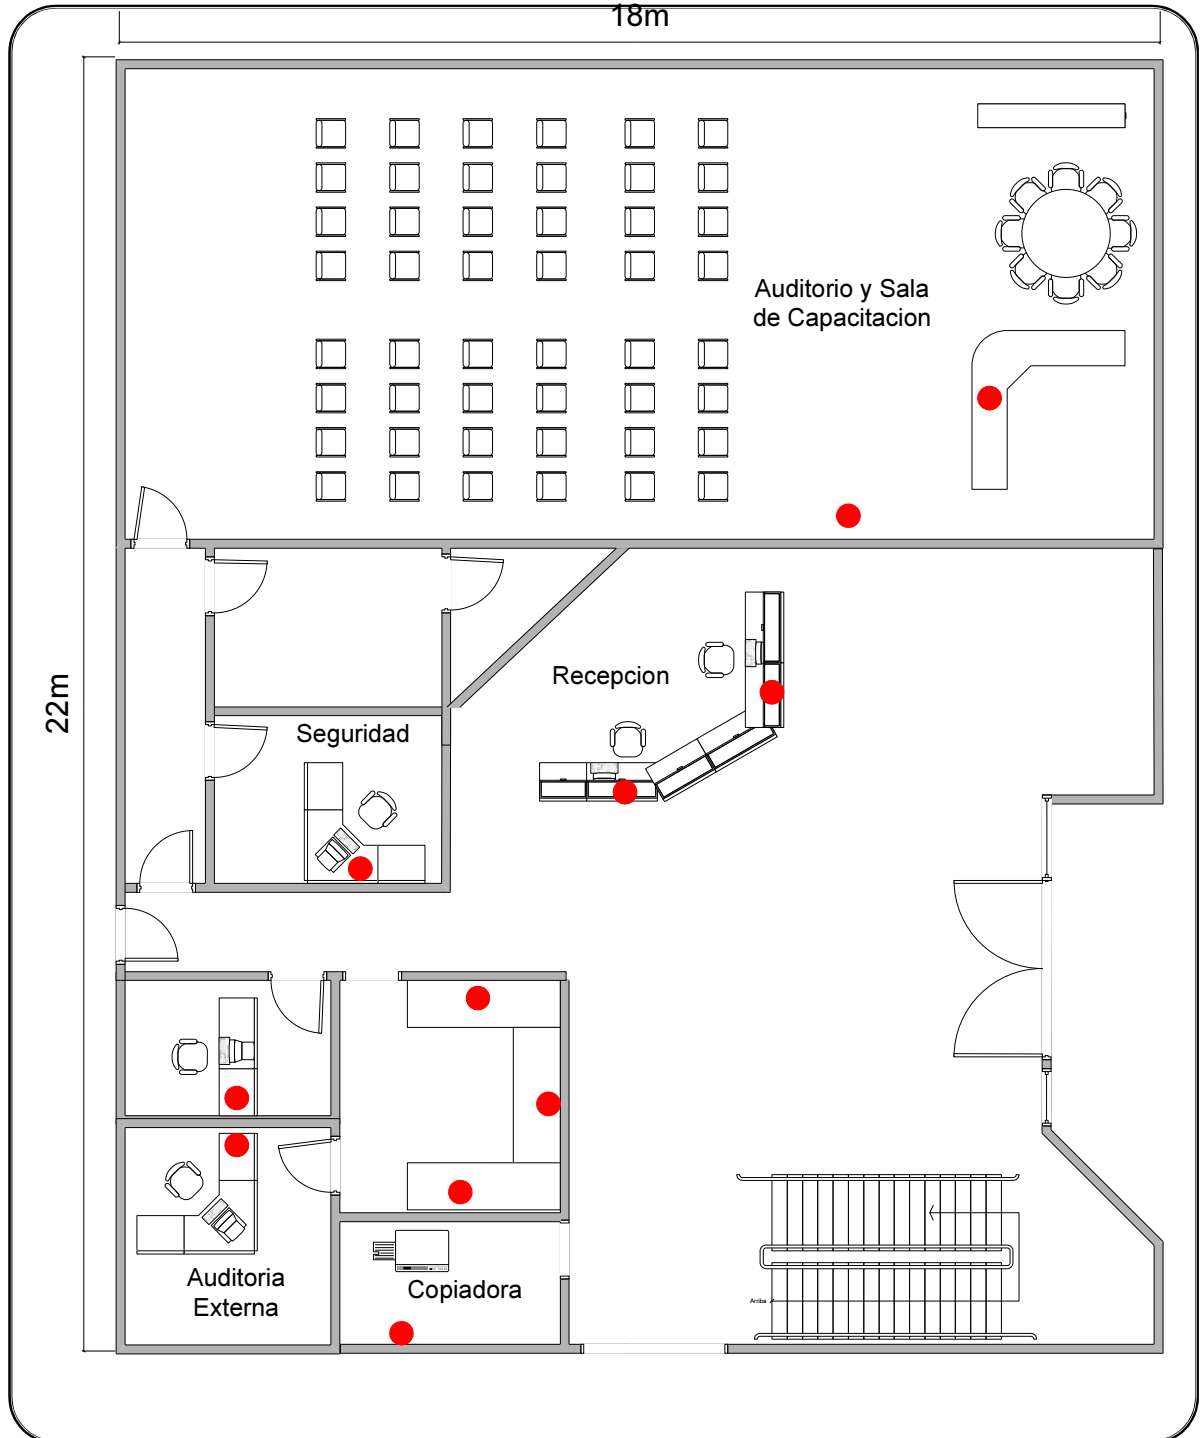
4 LAN Edificio Farmaenlace Planta Baja
